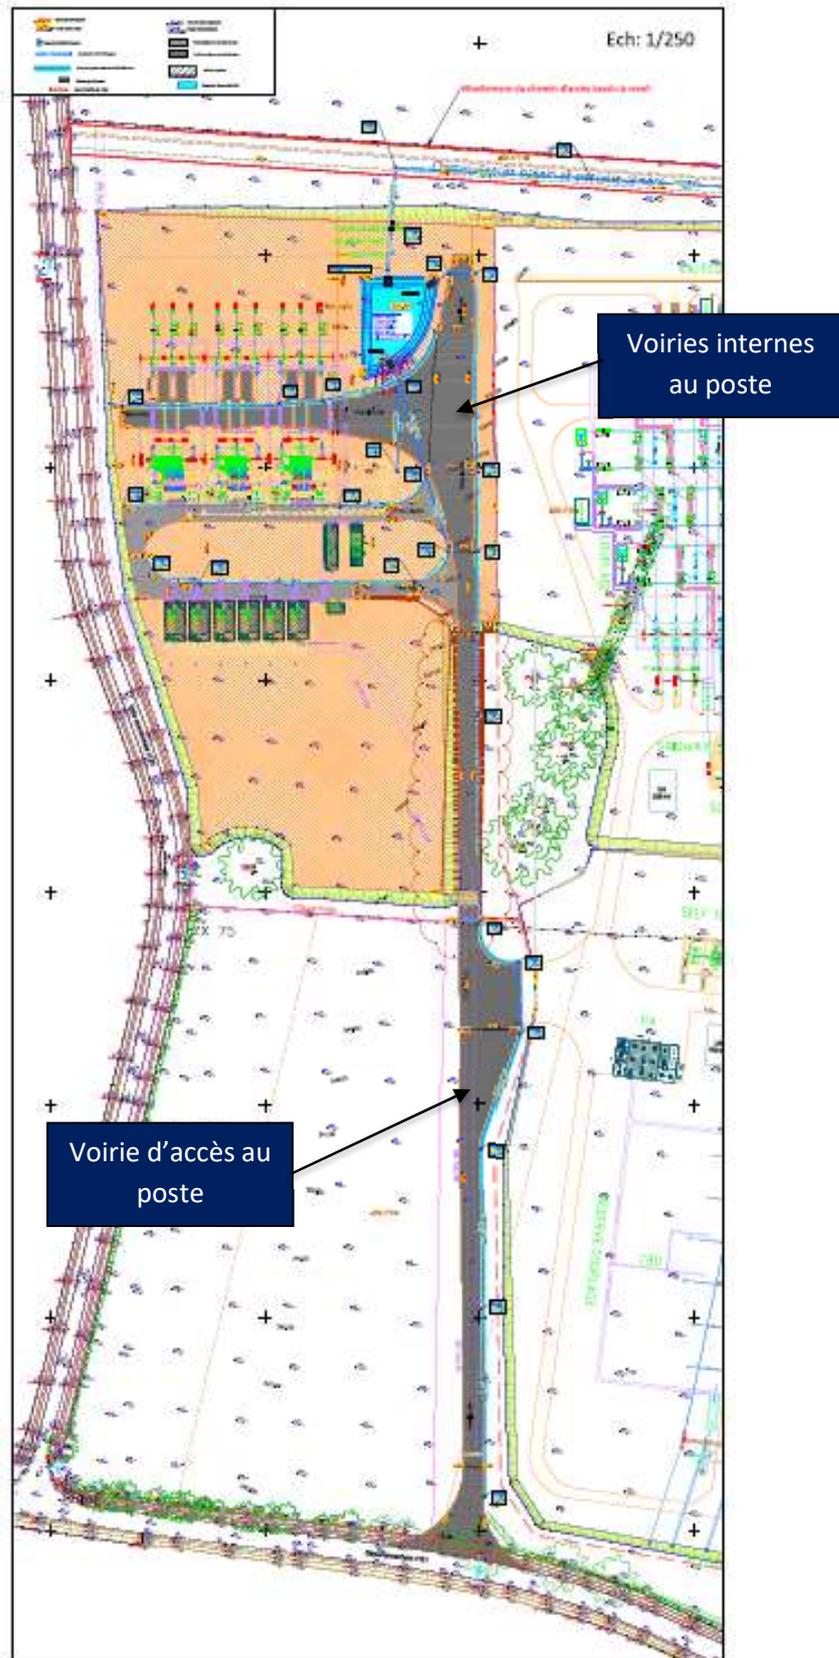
Plan masse du projet y compris voirie d'accès – PS de Saint-Hilaire (Source : ENEDIS - BRIPS)
